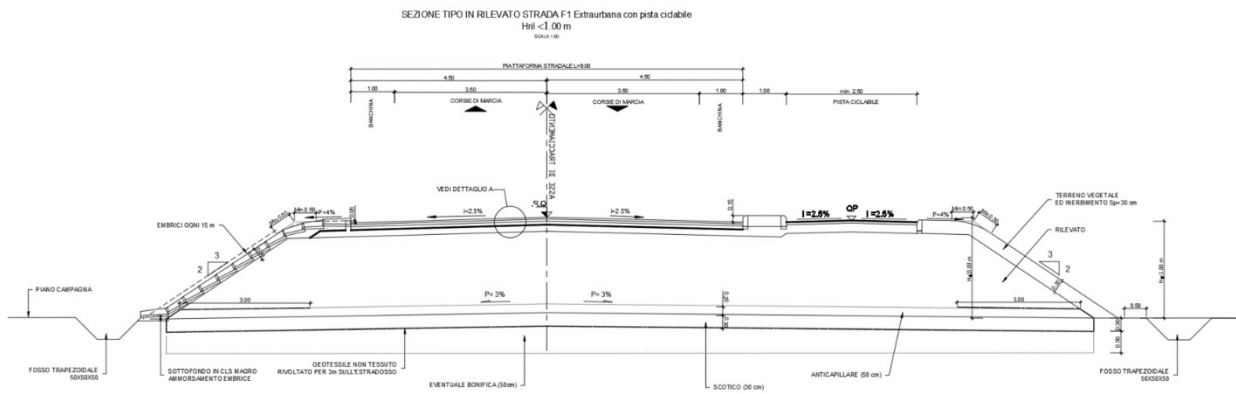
Sezione tipo di progetto in rilevato senza barriera
